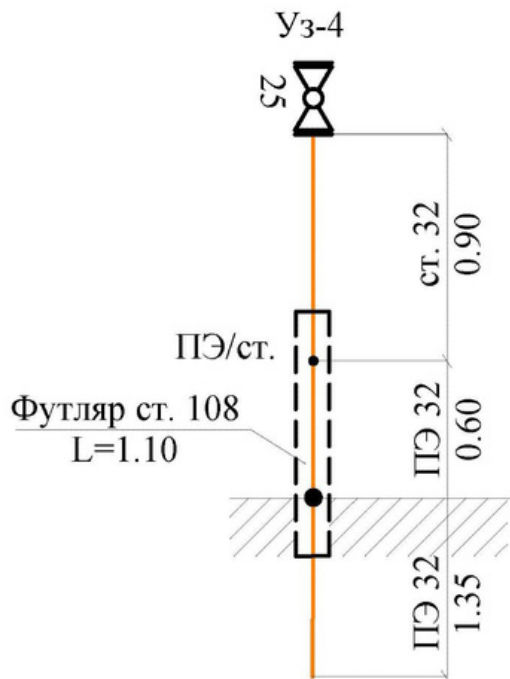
Фрагмент ситуационного плана с отображением детального плана части газопровода-ввода
